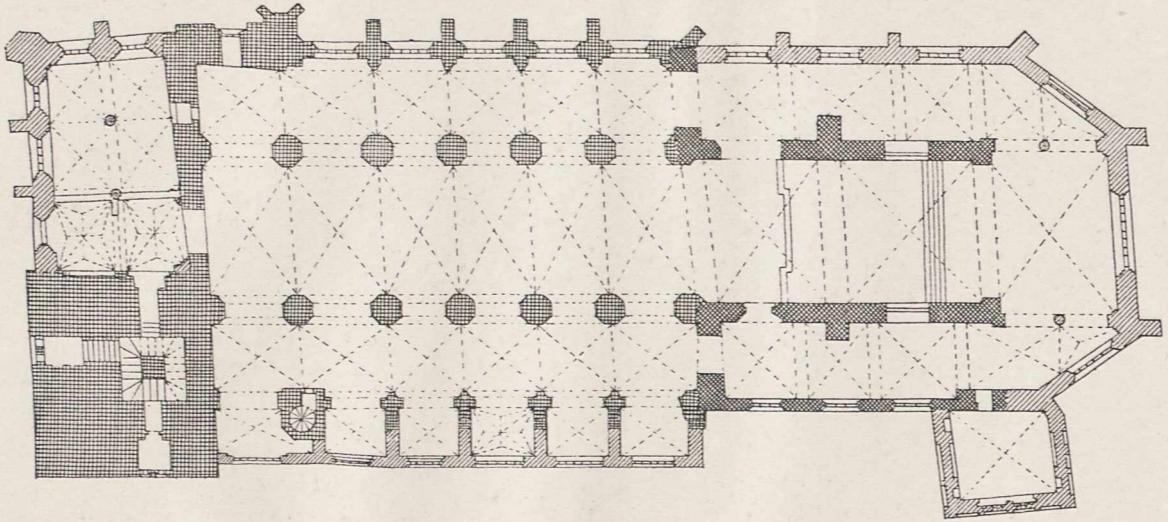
Anklam; Marienkirche, Grundriss. 1:500.
